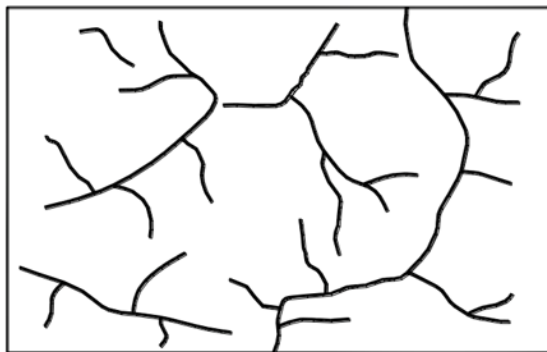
Detalle de fisuras de ataque por sulfatos 1
